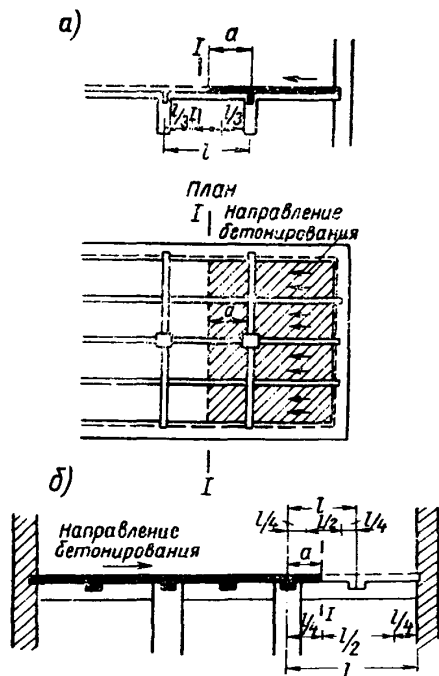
Расположение рабочих швов при бетонировании ребристых перекрытий
